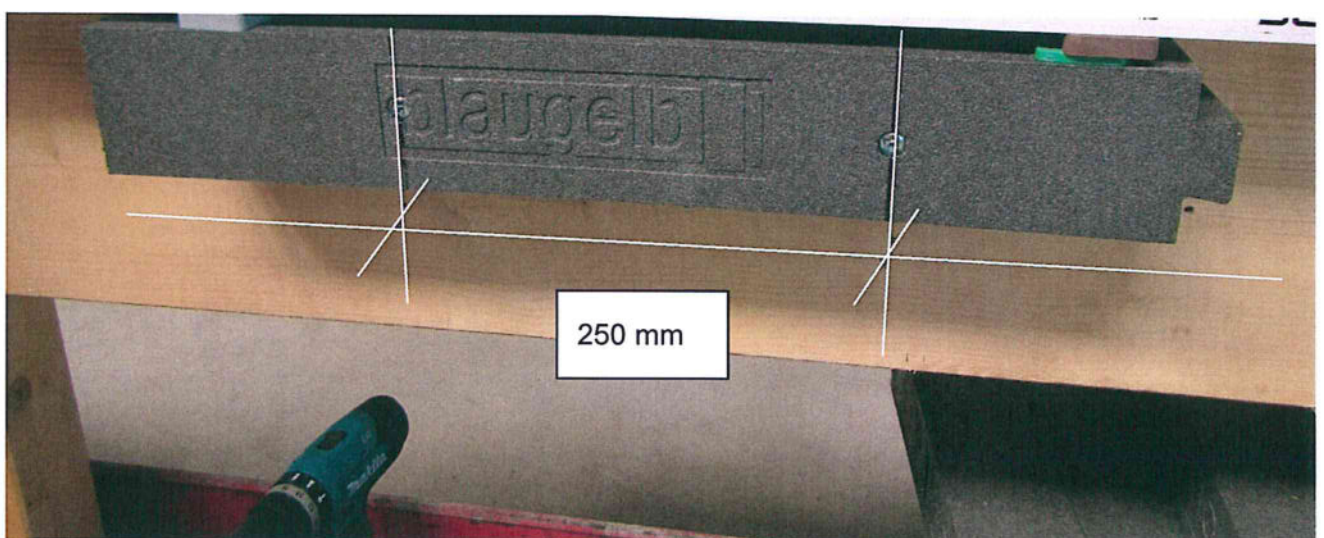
Ansicht auf den Befestigungspunkt am Rand mit dem Fensterrahmen und blaugelb Triothem+. Der Abstand der Verschraubung beträgt $e = 250$ mm im blaugelb Triothem+ zum Holzrahmen. Verschraubung je Befestigungspunkt mit drei blaugelb Rahmenfixschrauben (Drillingsverschraubung)
